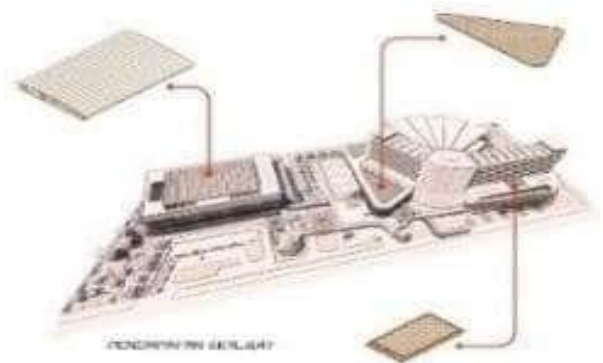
Selubung Bangunan pada Arah Timur dan Barat
